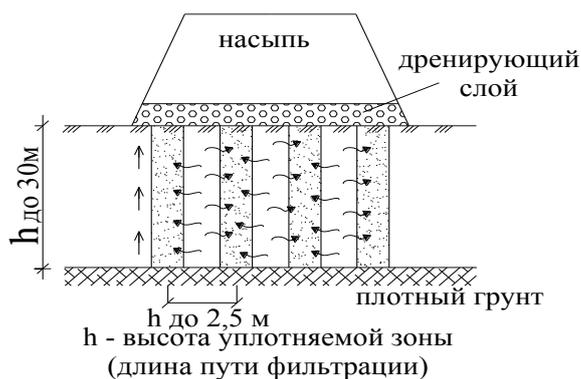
Схема уплотнения грунтов с помощью вертикальных дрен
